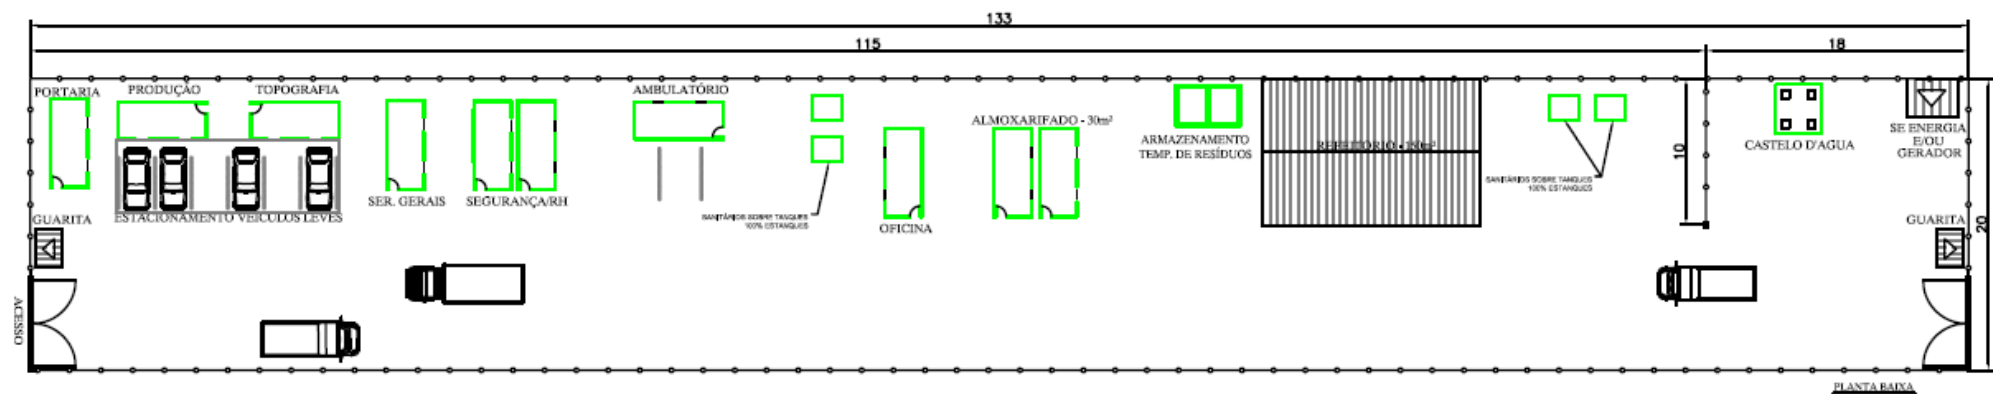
Layout do canteiro avançado padrão (ou de frente de serviço)
